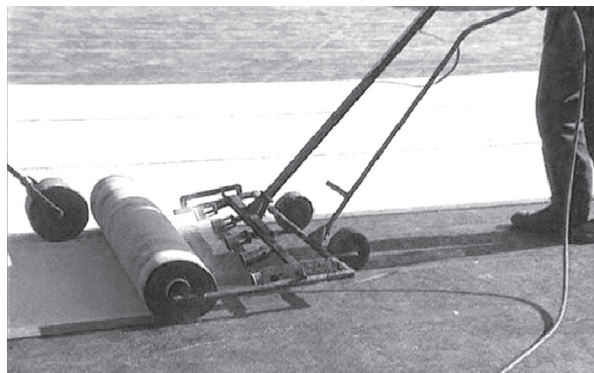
Un trabajador del techado empuja la carretilla de soplete de espaldas.
